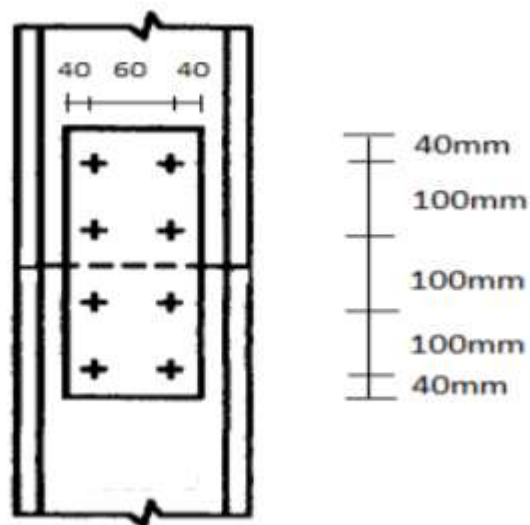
assemblage poteau- poteau (couvre-joint de l'âme)
